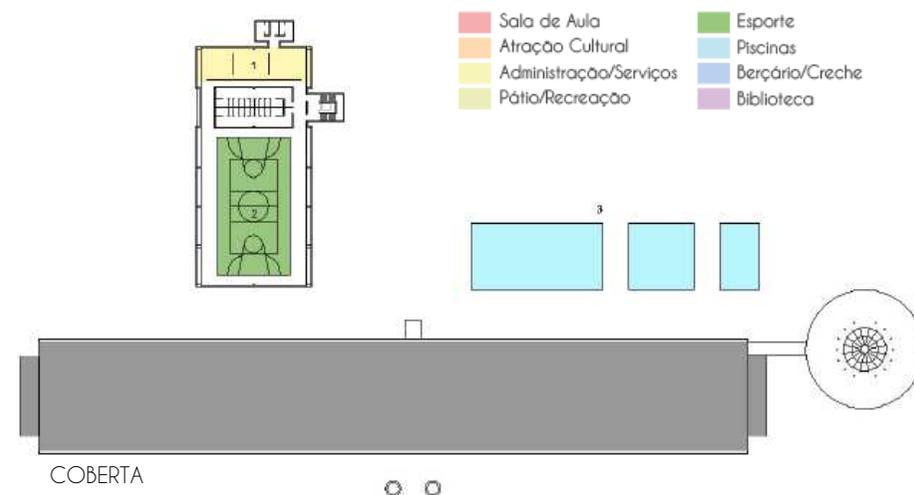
Projeto padrão CEUs - planta 1º pavimento. Fonte: Wilderom, 2014, p. 121, editado pela autora.
